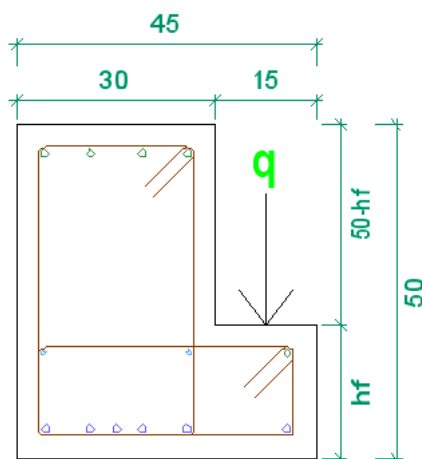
ESQUEMA DE SECCIÓN DE VIGA EN L
